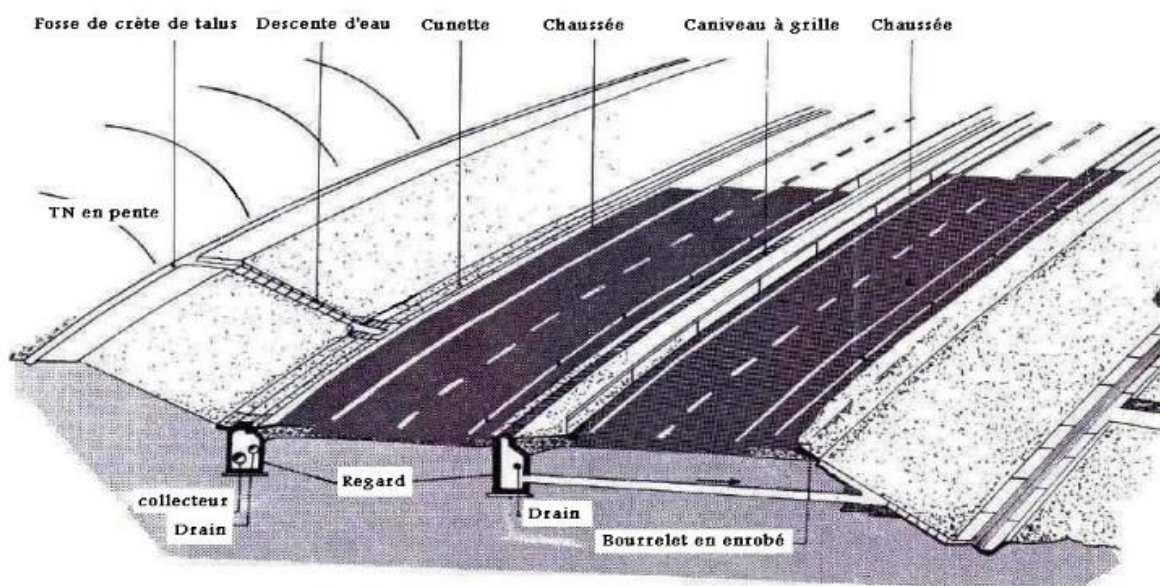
l'Emplacement des Ouvrages d'Assainissements.
